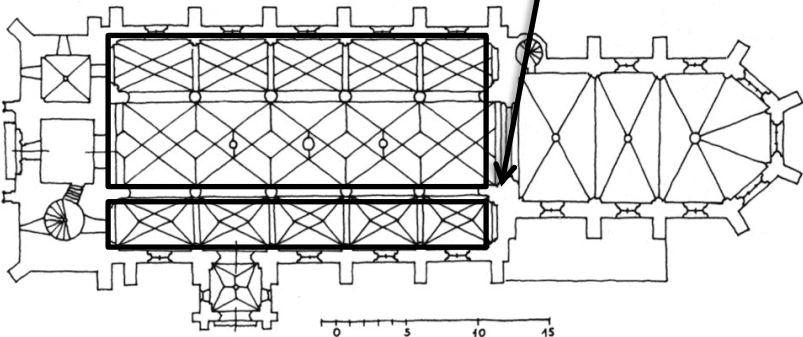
Rockeskyll, St. Bartholomäus, Grundriss
